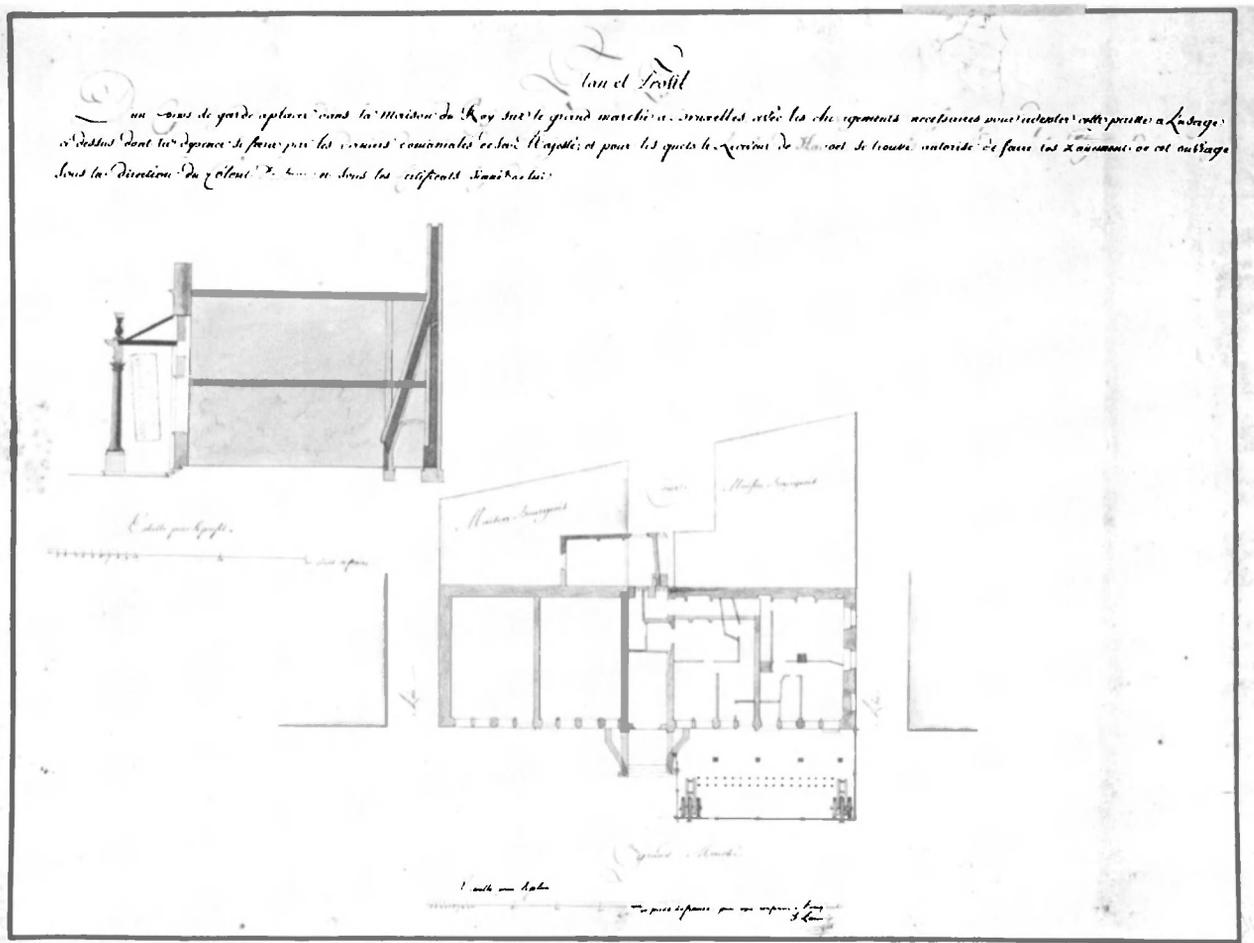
Plan et profil du corps de garde adossé à la Maison du Roi, 1788, doc. A.G.R.
